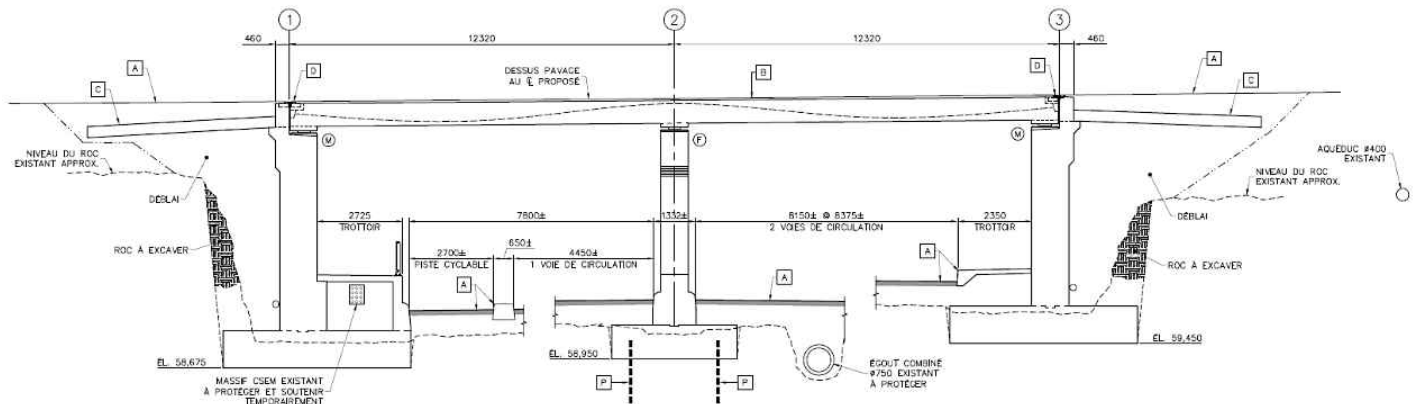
Extrait du plan d'ensemble du scénario 2 – Option dalle épaisse en béton précontraint – Coupe au CL proposé
